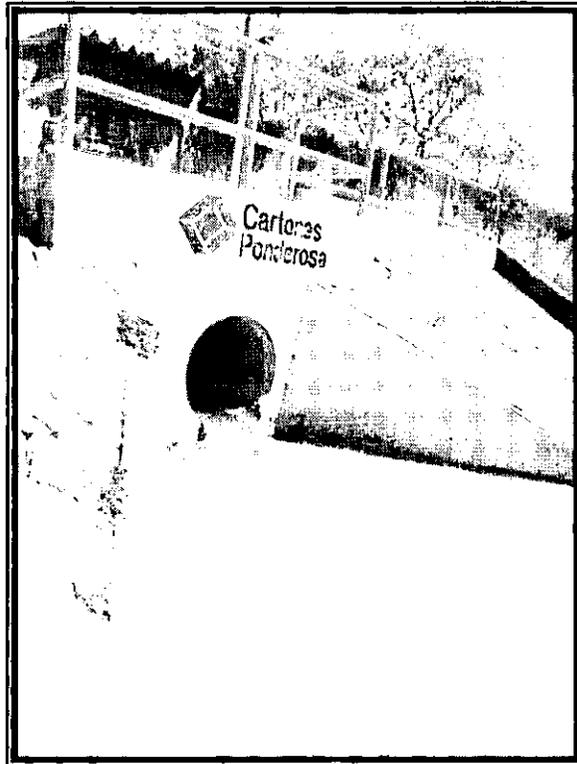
Estructura de descarga de la industria Cartones Ponderosa
